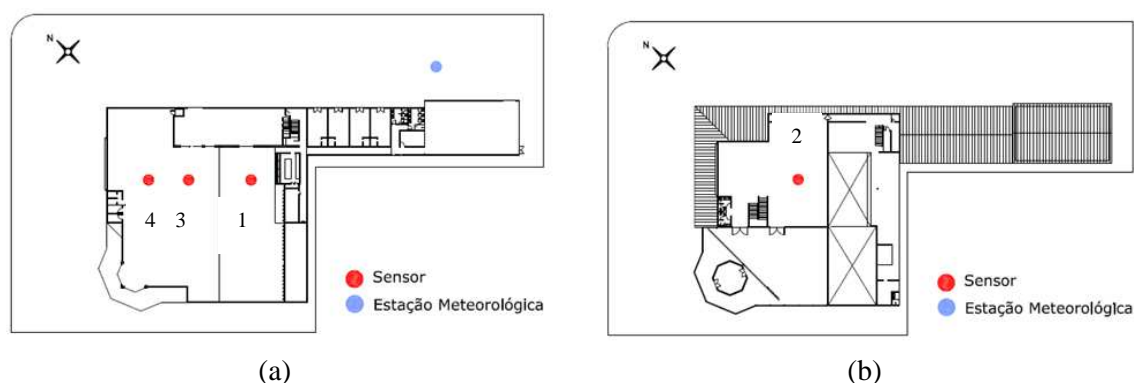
Posicionamento dos equipamentos de medição no Pavimento térreo (a) e Posicionamento dos equipamentos de medição no Pavimento superior (b)
